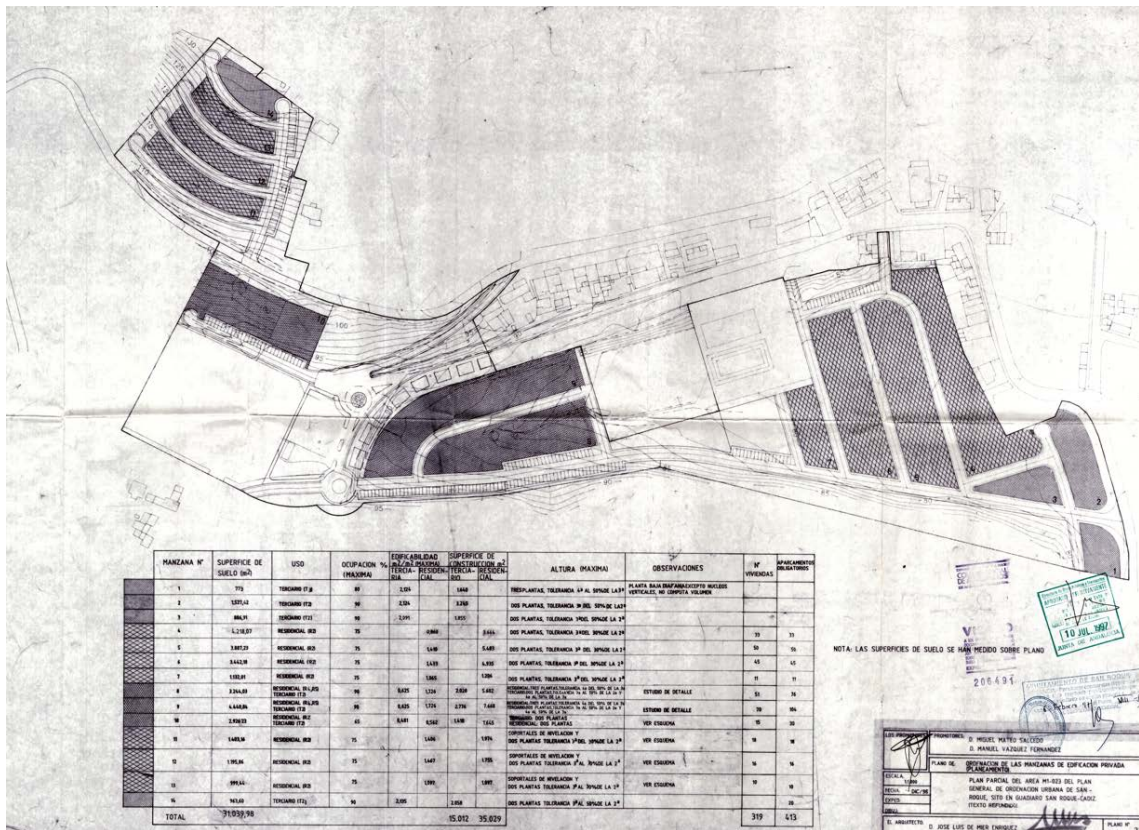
PLAN PARCIAL DE AREA MI-23 .PLANO 22 ORDENACION DE MANZANAS DE EDIFICACION PRIVADA. APROBADO DEFINITIVAMENTE 10 JULIO DE 1997
